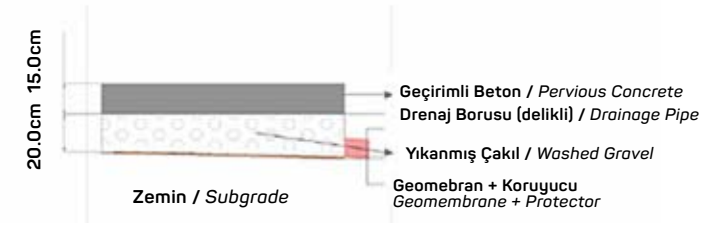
Yağmur Bahçesi ve Geçirimli Beton Yerleşim Planı
